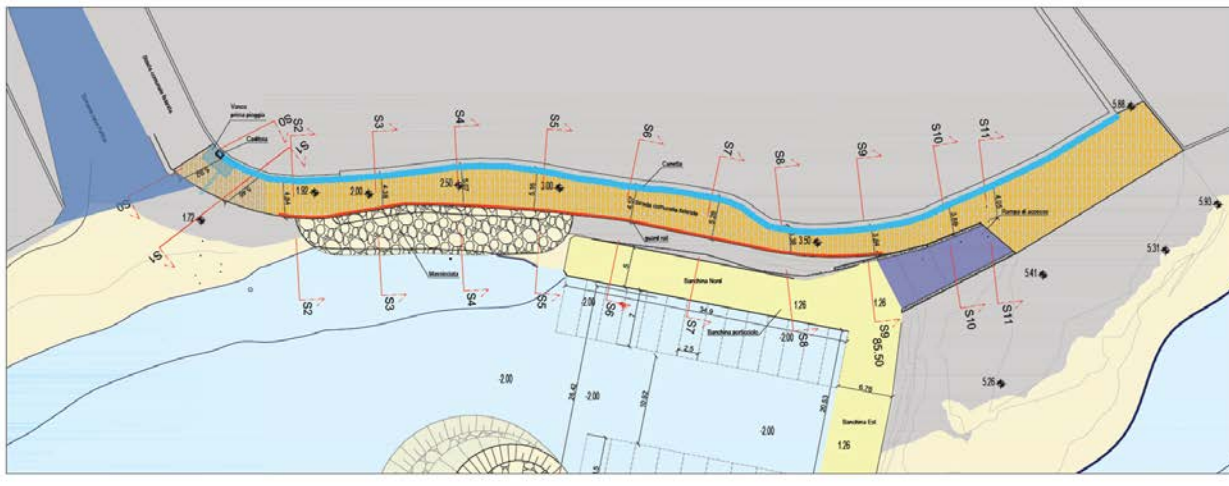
Planimetria sistemazione viabilità di accesso al riparo per la pesca
